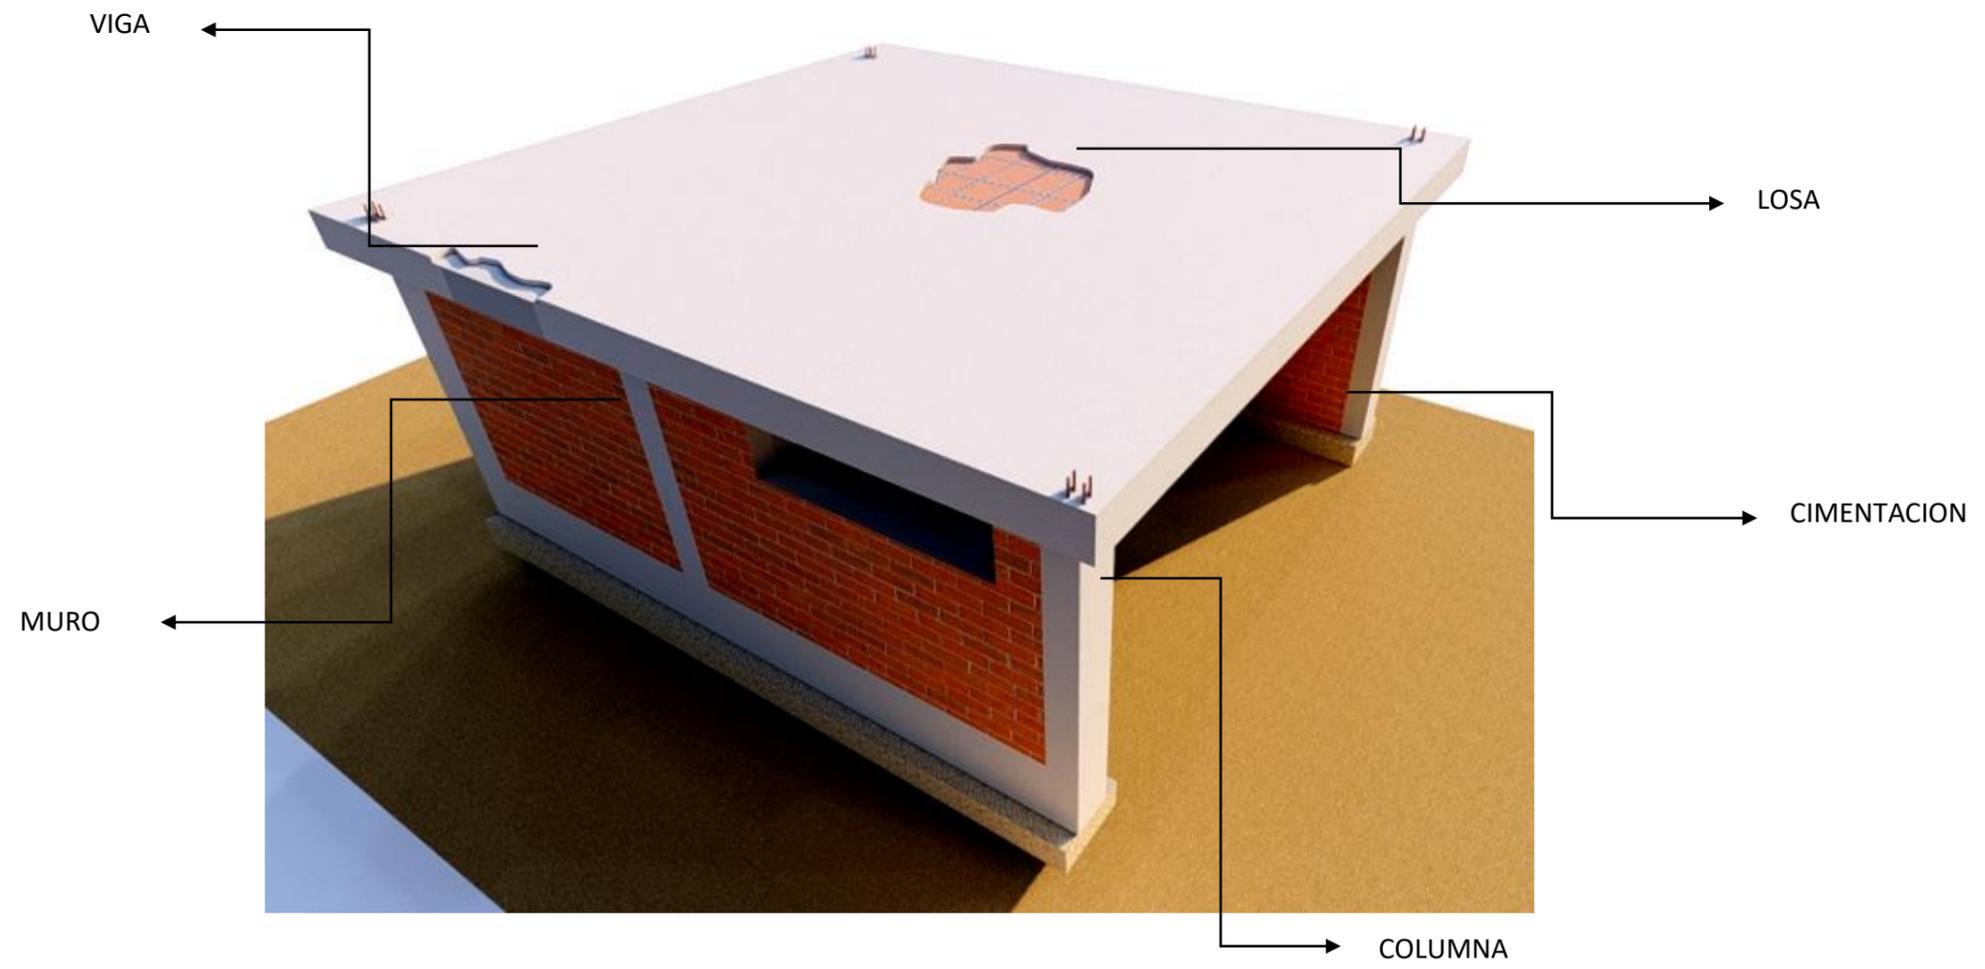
elementos estructurales de una vivienda de albañilería confinada (AREQUIPA, 2010)
